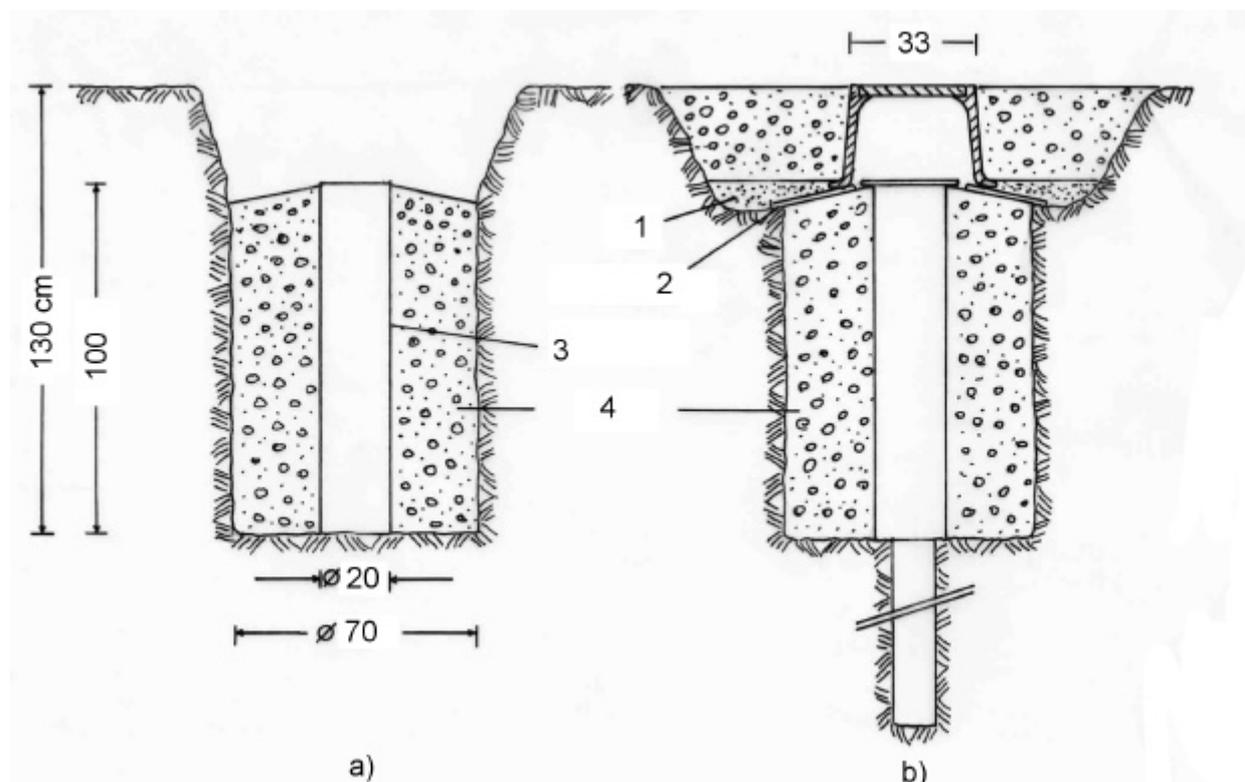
Formation d'une tête d'extensomètre avec fondation antigel
